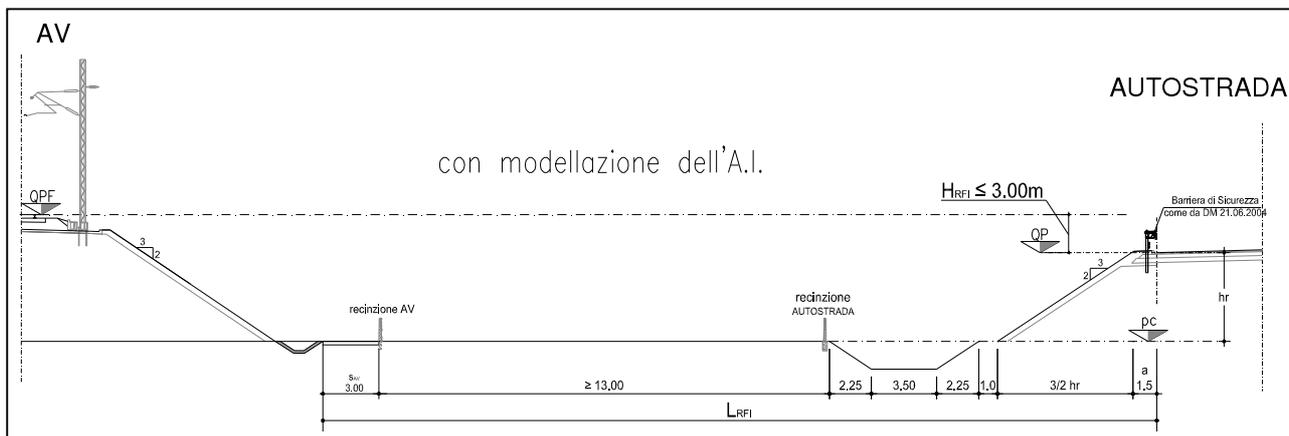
Sezione tipo dell'area interclusa con cunettone – ZONA Aa3
